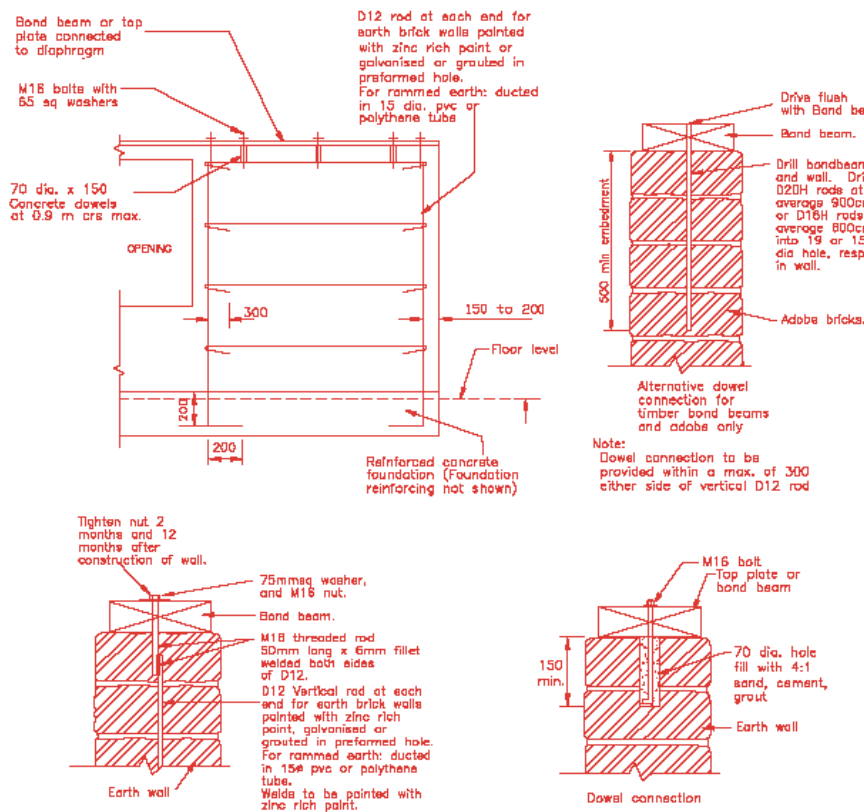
Raccordements de renforcement et de doigt pour renforcés les murs
